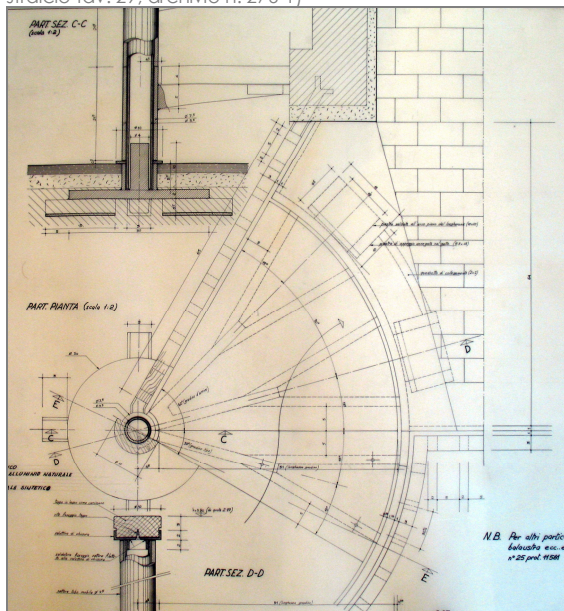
scala di servizio: particolare (fonte CSAC – stralcio tav. 29, archivio n. 276-1)
